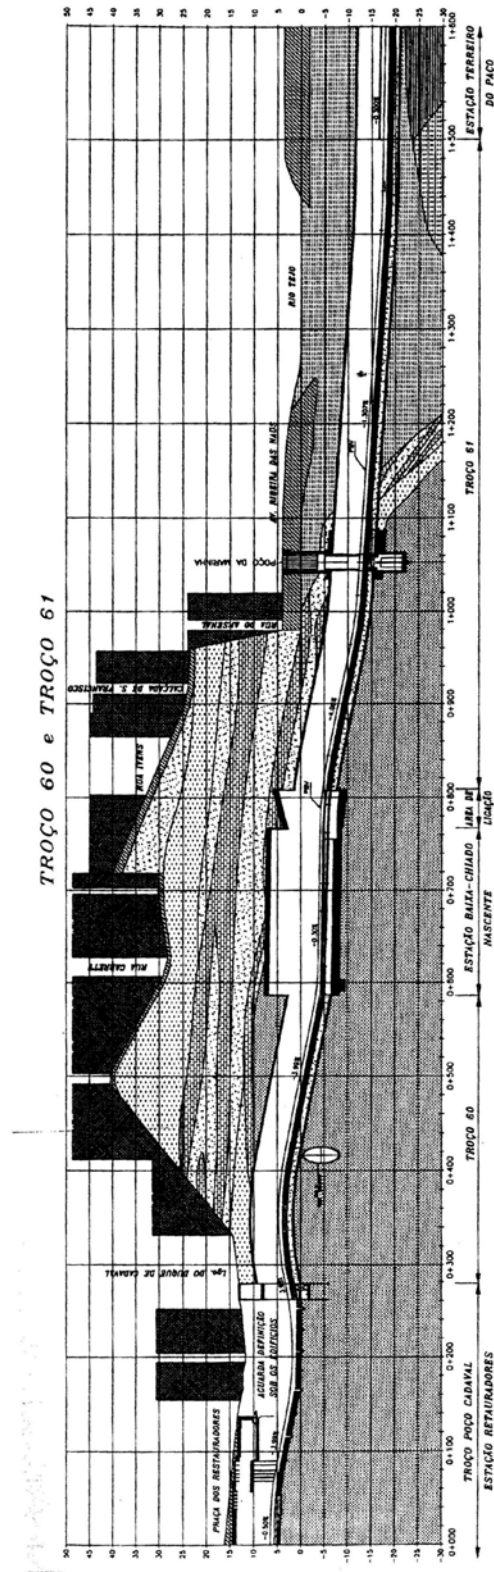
Perfil longitudinal dos troços 60 – Baixa/Chiado – Restauradores e 61 – Baixa/Chiado – Terreiro do Paço
